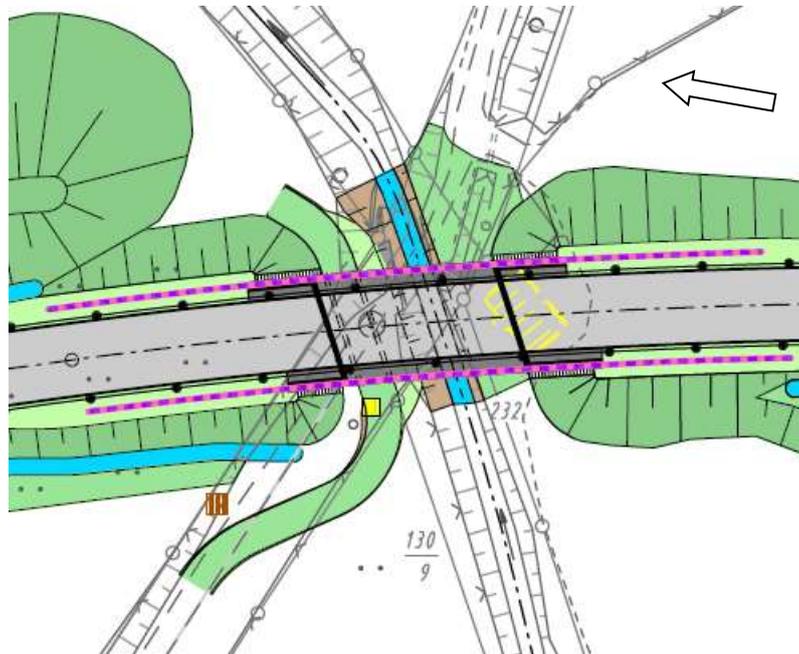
Lageplan des künftigen Bauwerks Gerb 01 über die Muse
